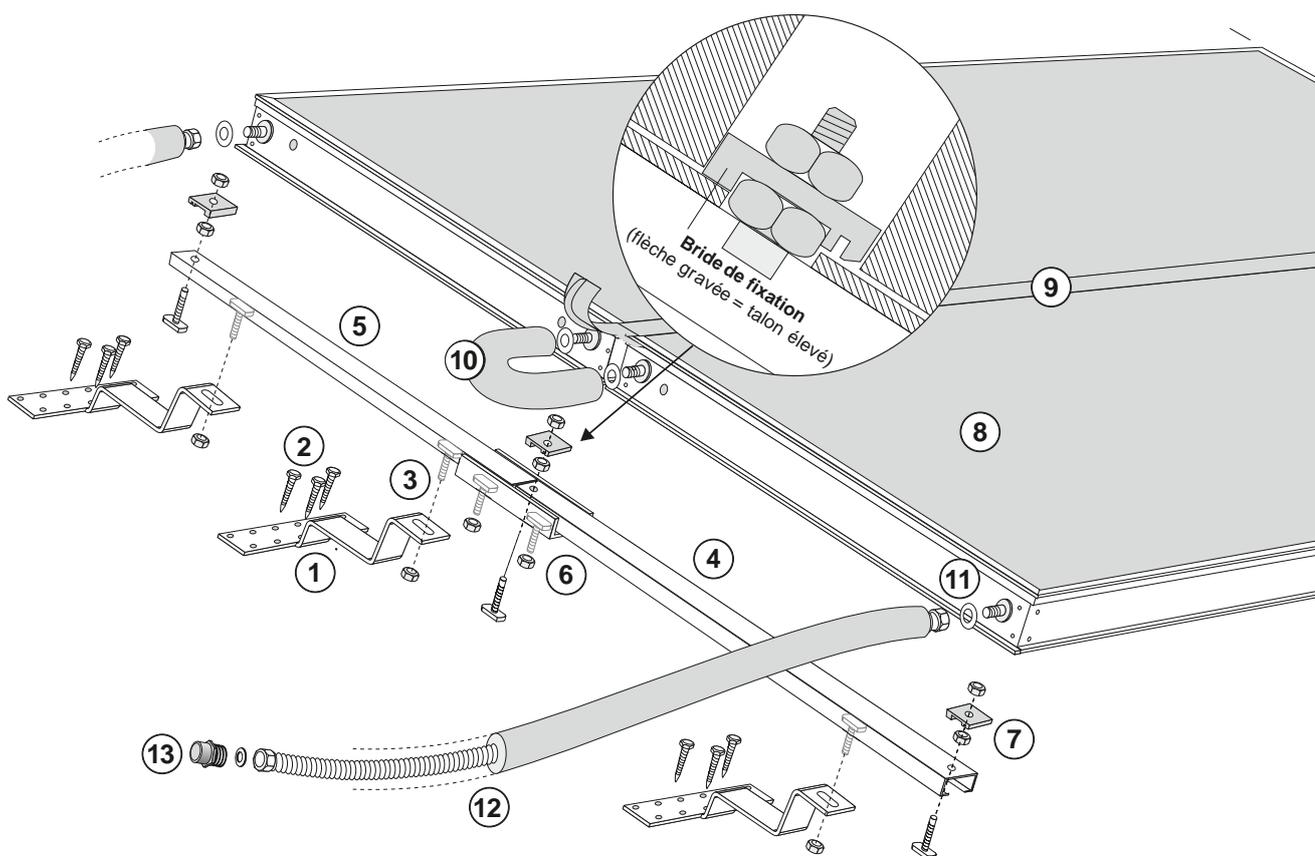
Kit standard pour montage sur toiture de 2 capteurs HeliPlan N avec pose horizontale ou verticale : 1 patte de fixation sur chevrons, 2 vis à bois 6x80, 3 vis à tête marteau en inox M10x30 avec écrou, 4 profilé de montage de base en aluminium, 5 profilé d'extension, 6 pièces d'accouplement avec vis à tête marteau en inox M10x30 avec écrou, 7 bride de fixation HeliPlan N avec vis à tête marteau en inox M10x30 et 2 écrous, 8 capteur HeliPlan N (non compris dans le kit), 9 profilé d'étanchéité T en silicone, 10 flexible inox. avec écrou de raccord 1/2" et isolation 20x13 mm, long. 250 mm, 11 joint d'étanchéité, 12 flexible inox. avec raccord 1/2" et isolation 20x13 mm, long. 900 mm, 13 raccord à souder 1/2" 18 mm
